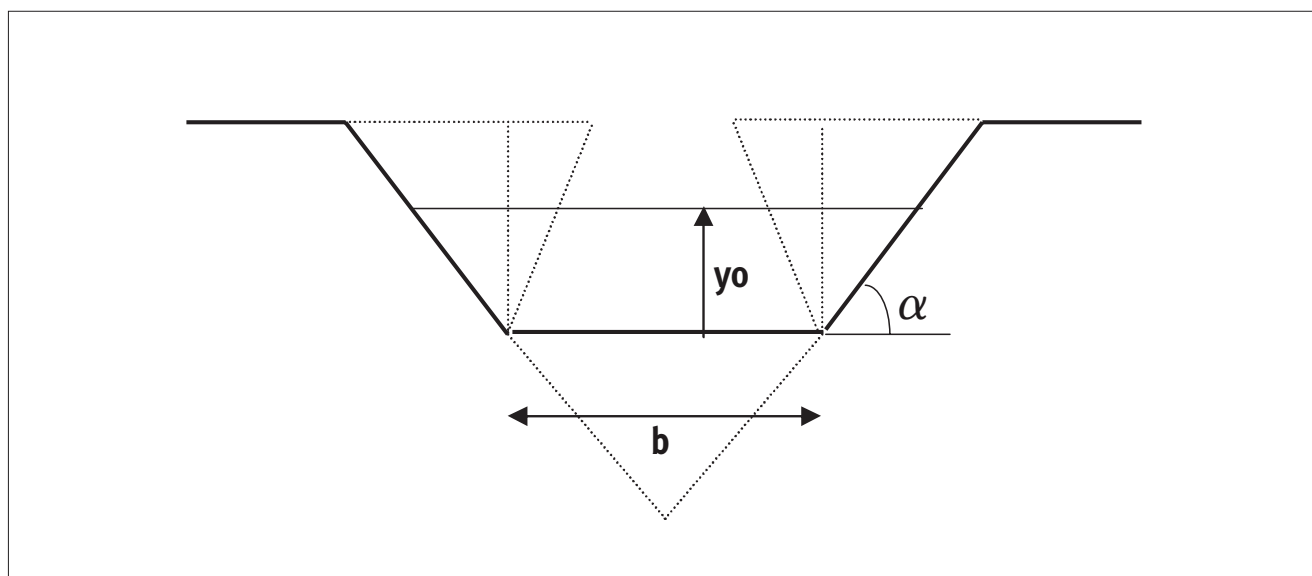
Seção trapezoidal típica de canais de condução de vinhaça.
